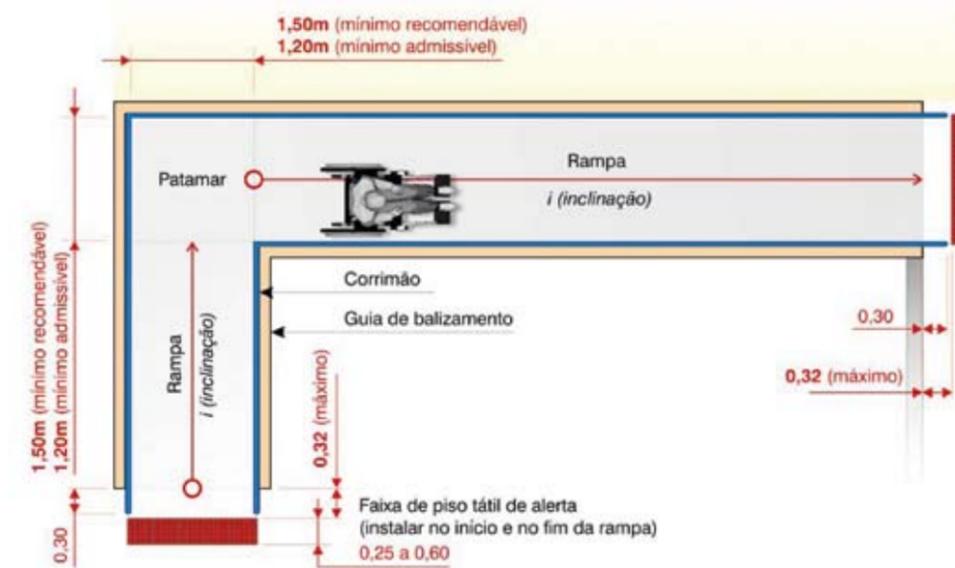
Dimensionamento e inclinação longitudinal de rampas – Vista superior
